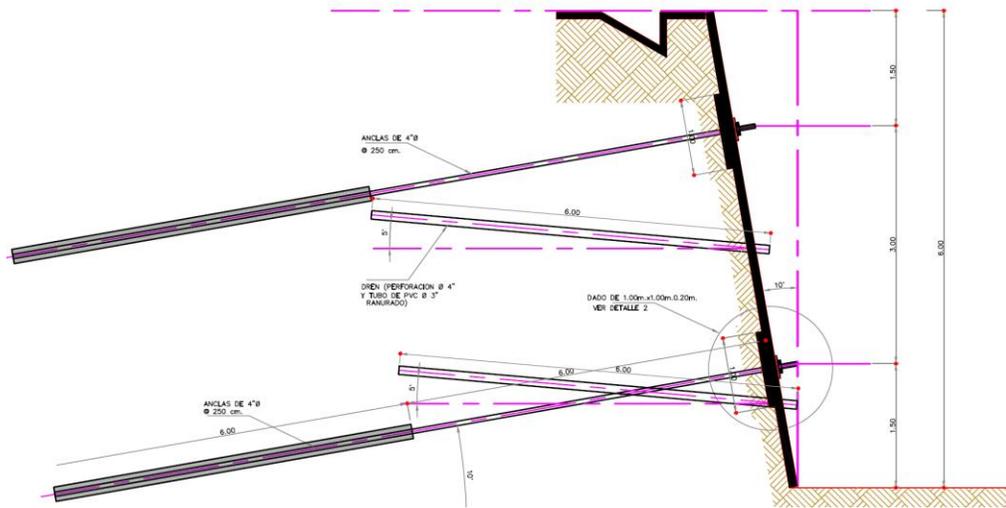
Vista de perfil del sistema de barrenos, anclajes y drenes, para la consolidación del risco.
